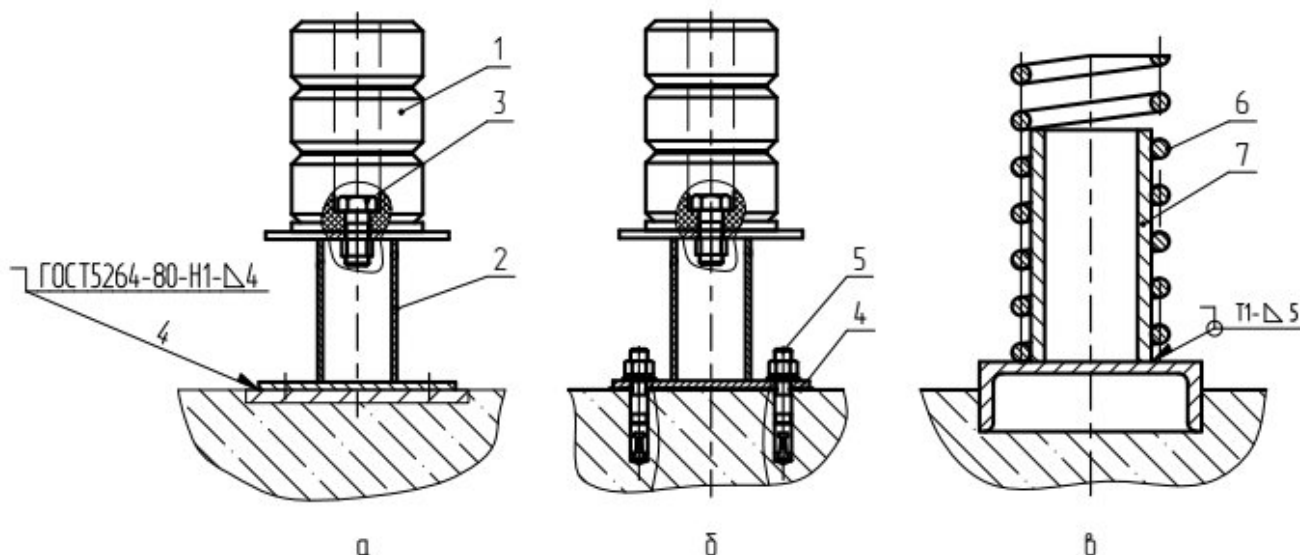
Схема крепления буфера в приямке а) сваркой б) анкерами в) пружинный буфер противовеса: 1 - Буфер полимерный; 2 - опора; 3 - болт; 4 - прокладка регулировочная; 5 - распорный анкер; 6 - пружина буфера; 7 - стакан (направляющая пружины).
